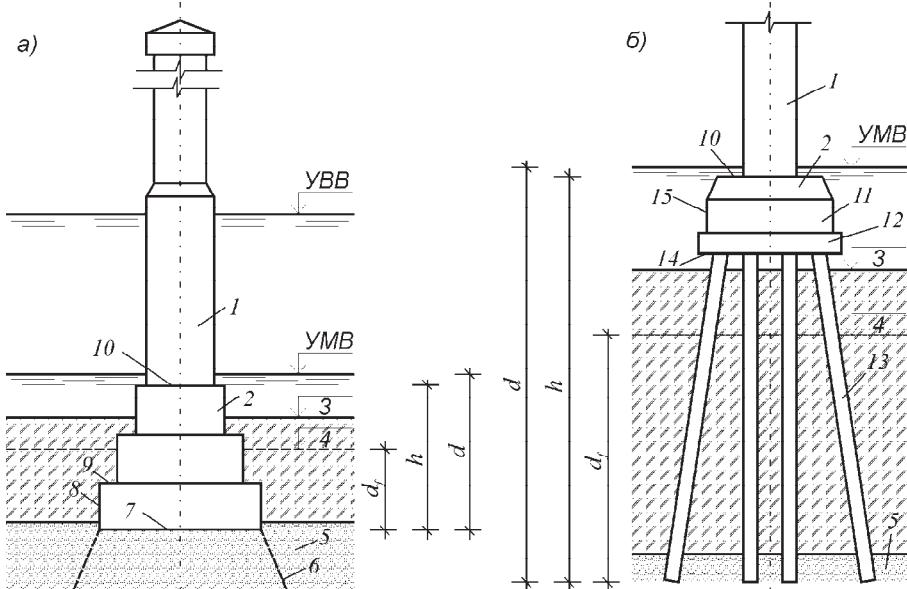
Фундаменты опор пешеходного моста: а – из одного несущего элемента; б – из куста несущих элементов; 1 – надфундаментная часть опоры; 2 – фундамент; 3 – поверхность грунта (дно водотока); 4 – уровень размыва; 5 – несущий слой грунта; 6 – условный контур основания; 7 – подошва фундамента; 8 – боковая грань фундамента; 9 – уступ; 10 – обрез фундамента; 11 – ростверк; 12 – тампонажный слой бетона; 13 – несущие элементы; 14 – подошва тампонажного слоя; 15 – боковая поверхность ростверка
